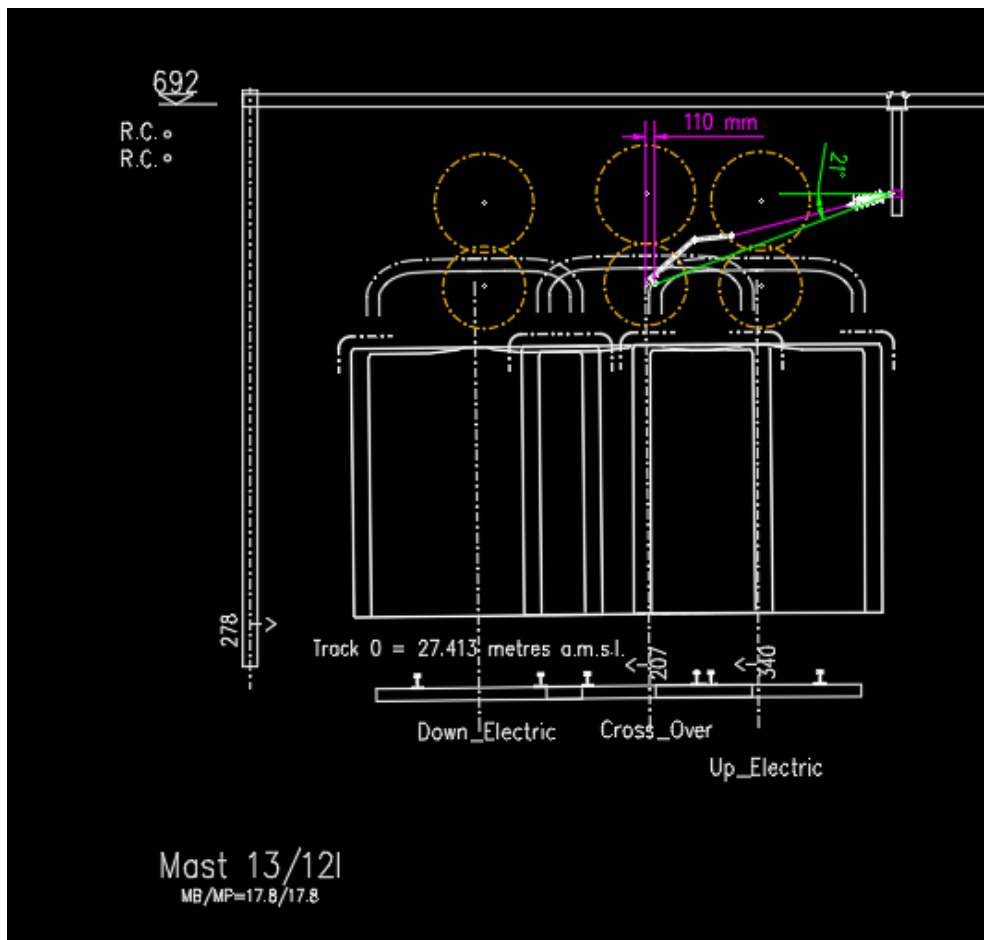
Brazo de atirantado instalado en la estructura NSR
